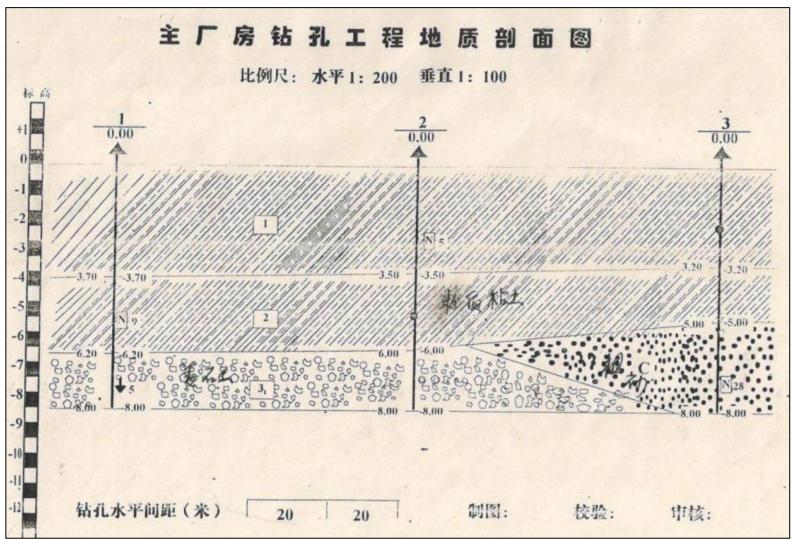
(1) 滕州亿达华闻煤电化有限公司工程地质剖面图
